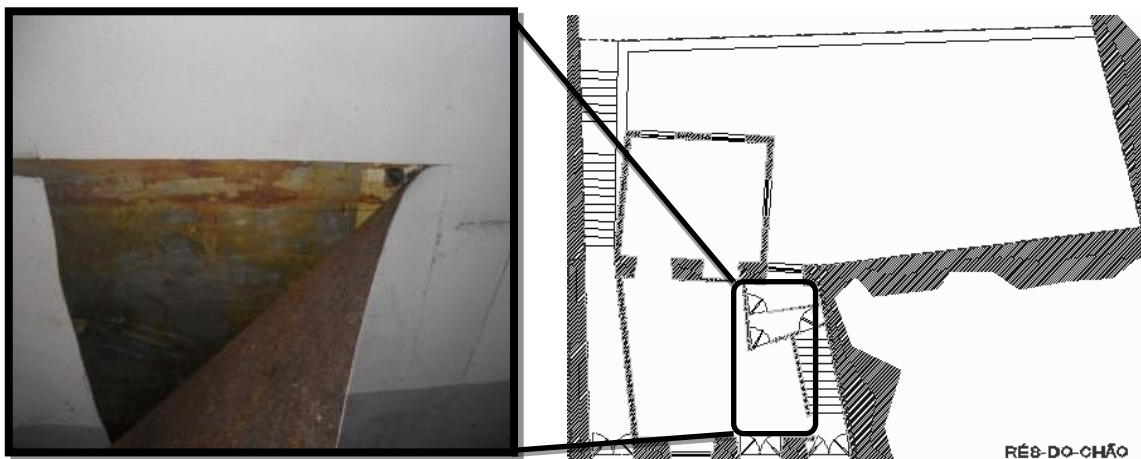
Anomalia 8 - Fotografia e localização em planta
